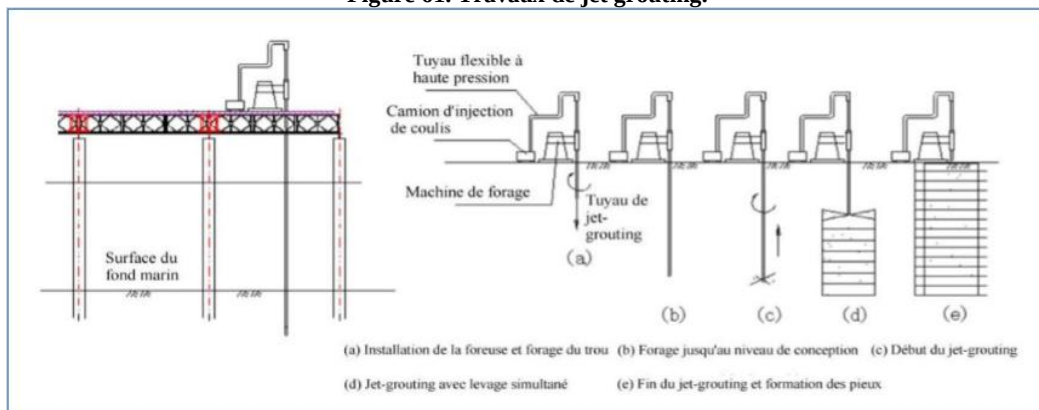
Schéma de construction des pieux de jet-grouting à haute pression.
